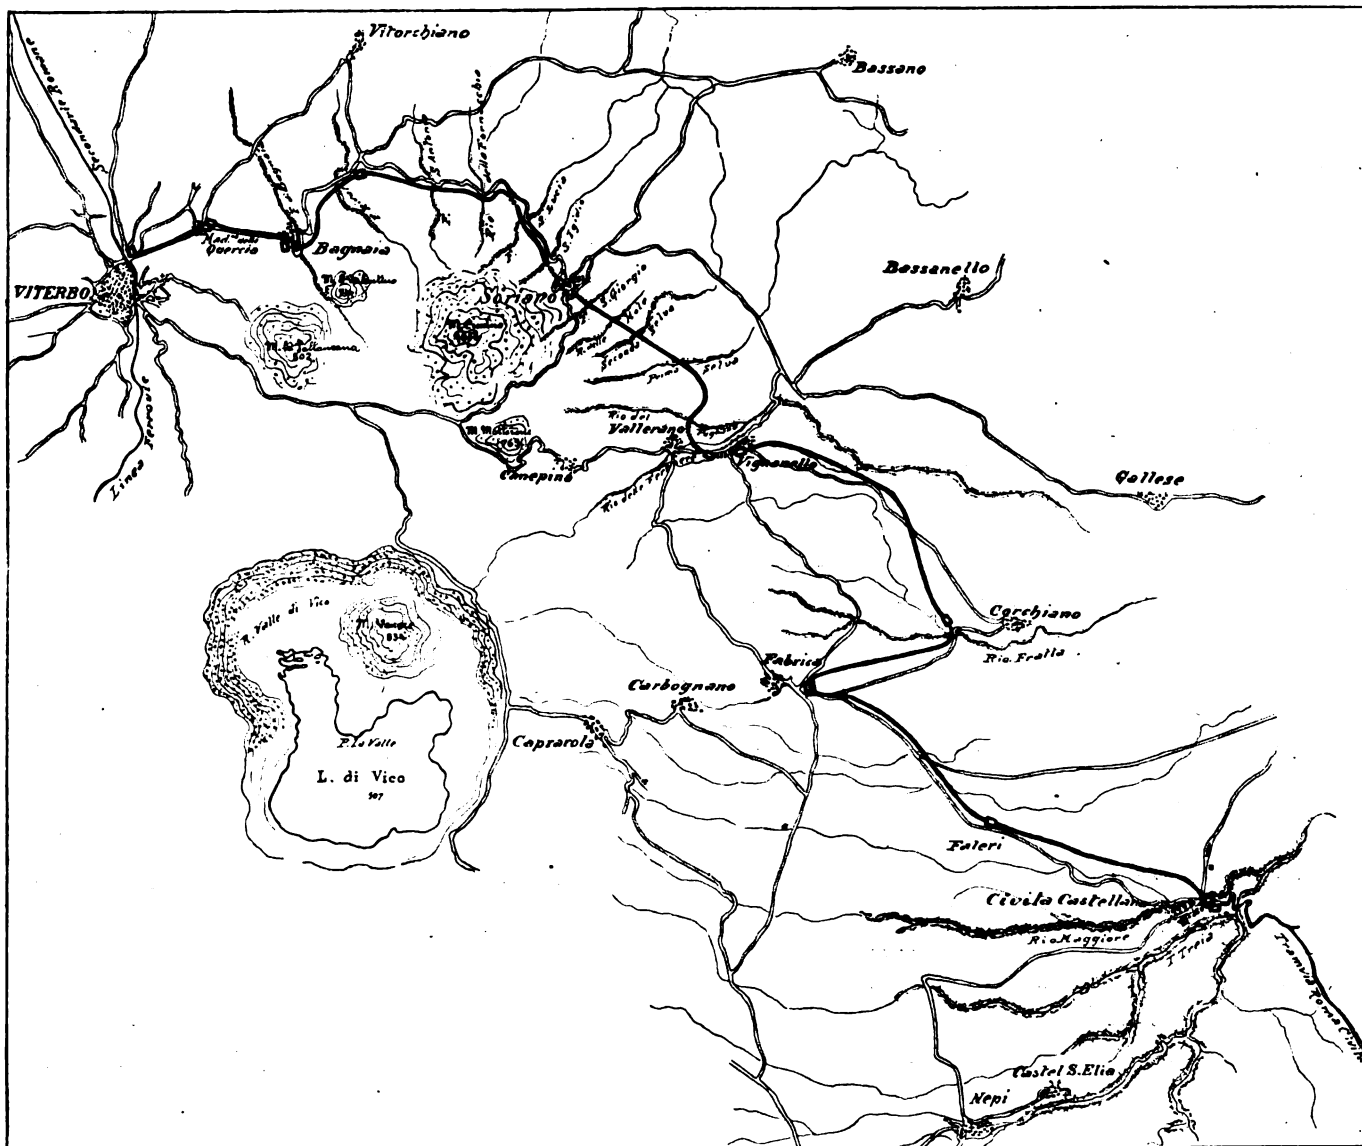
Ferrovia Civitacastellana - Viterbo. - Planimetria.
